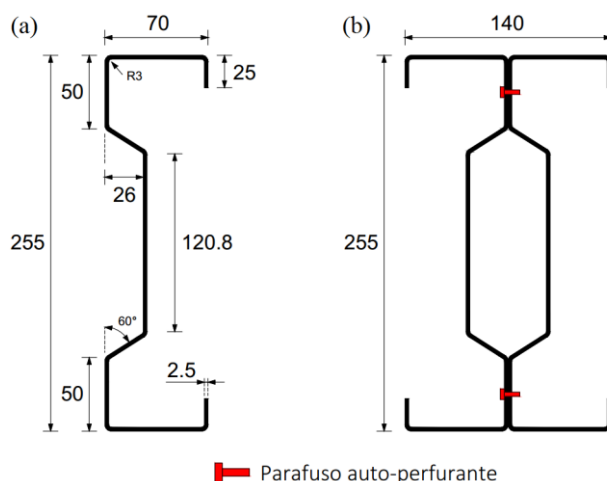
Dimensões das secções transversais (em mm): a) Secção Σ ; b) Secção 2Σ .
